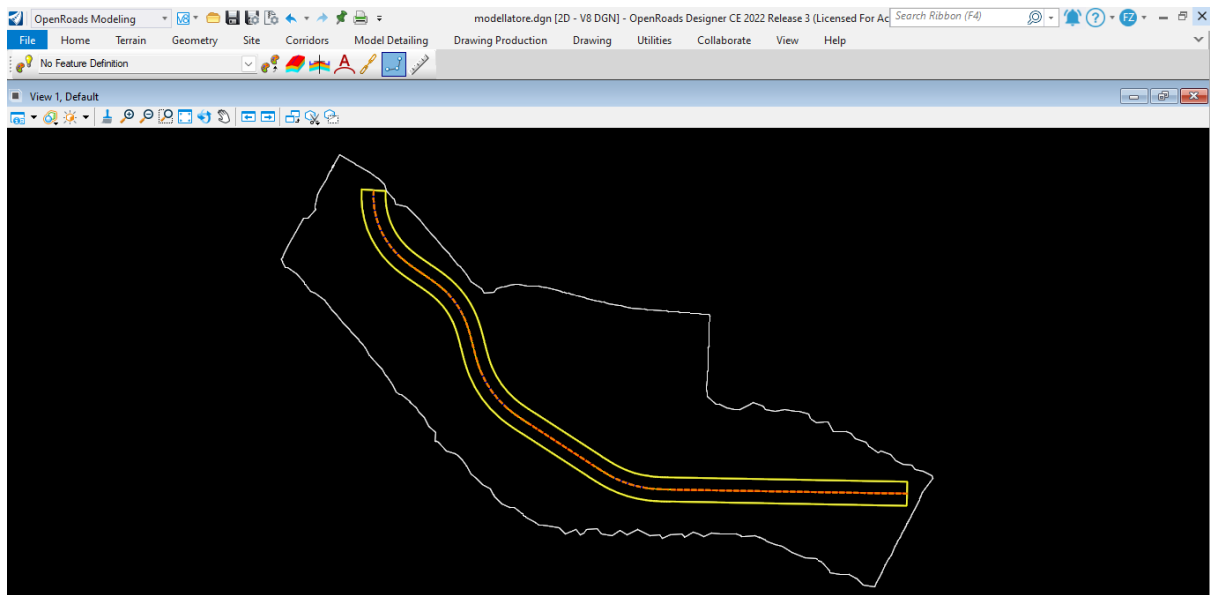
Sopraelevazione del tracciato vista in pianta
